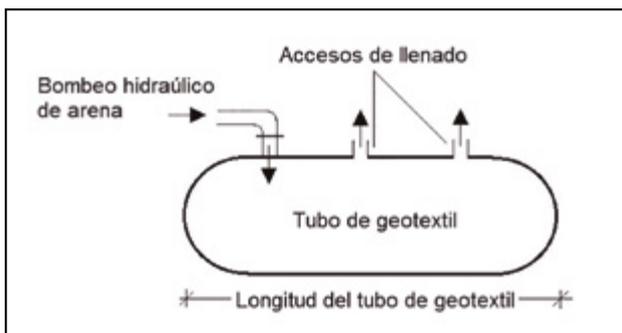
Principales características de la sección longitudinal del tubo de geotextil.
